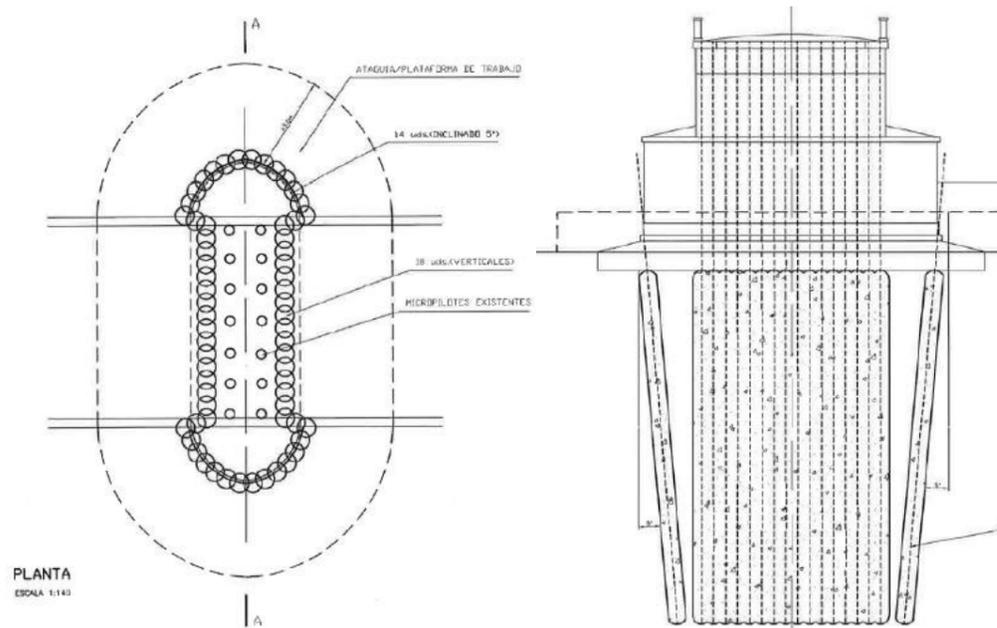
Disposición en planta (izquierda) y alzado (derecha) de la solución con jet grouting planteada en el proyecto de reparación de 2002 [2]
